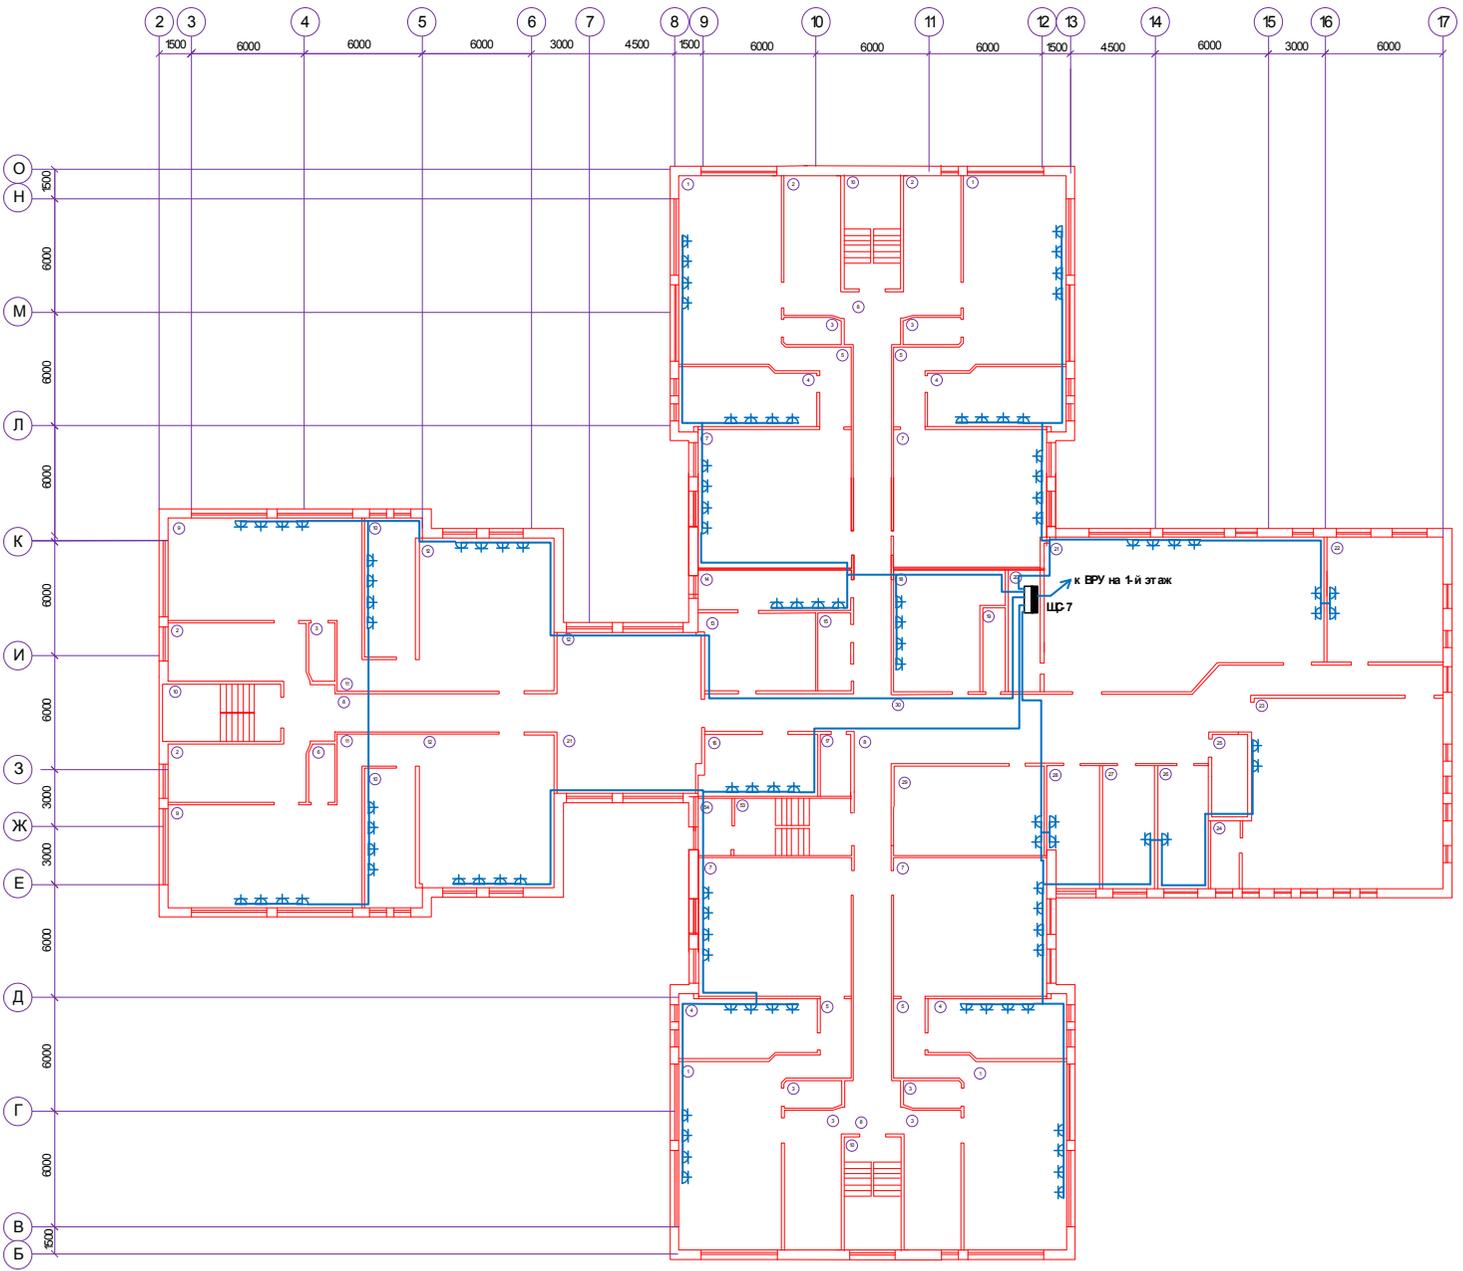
План силовых сетей 2-го этажа детского сада
